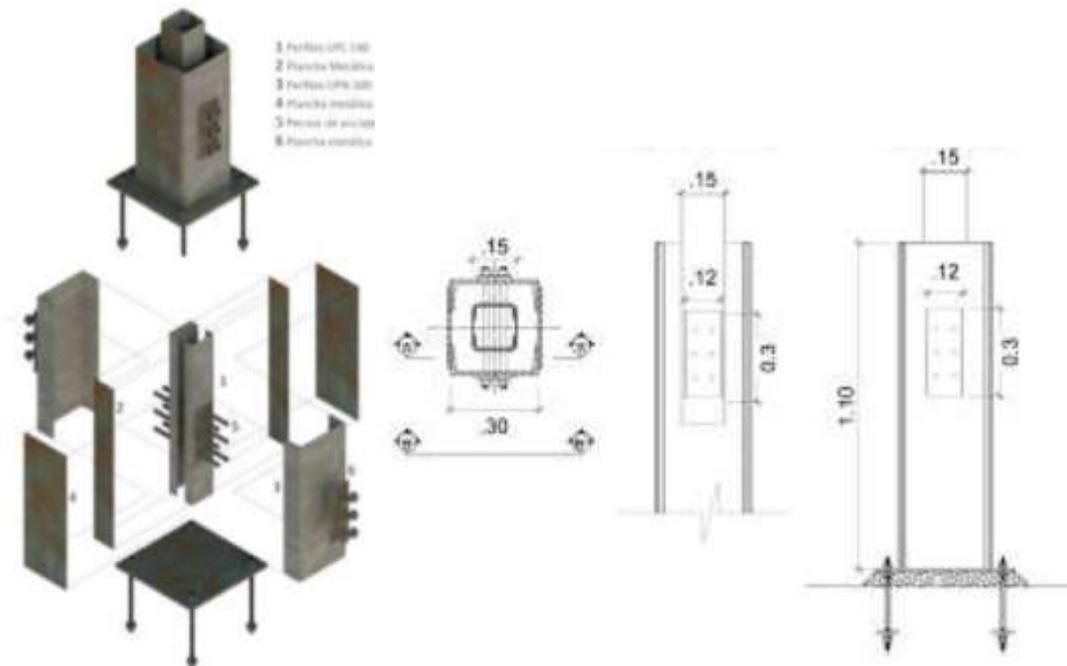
Componente estructural complemento de columna, para adaptación a terrenos en pendiente.
